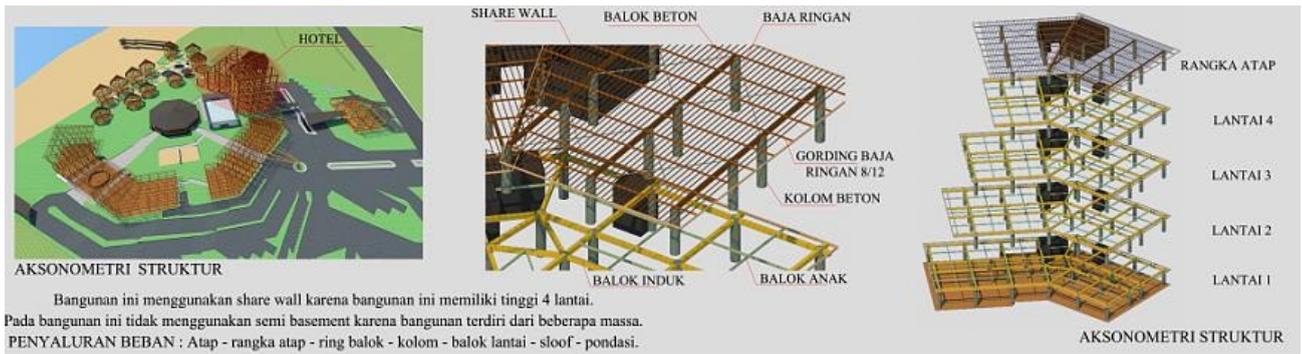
Kiri : pengaplikasian detail sambungan bangunan Hotel;
